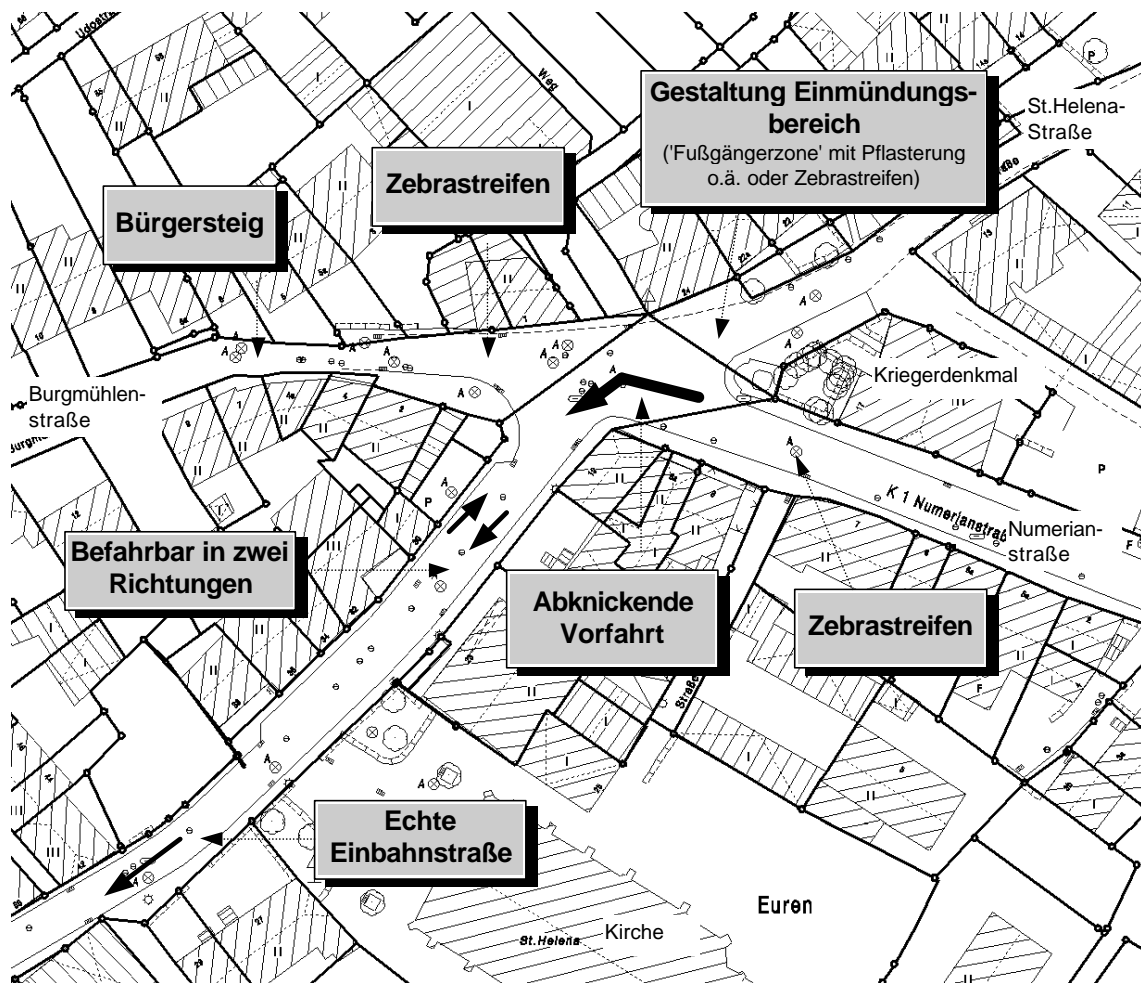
Kreuzungsbereich St.-Helena-Str. - Numerianstr. - Burgmühlenstraße (Kriegerdenkmal)
